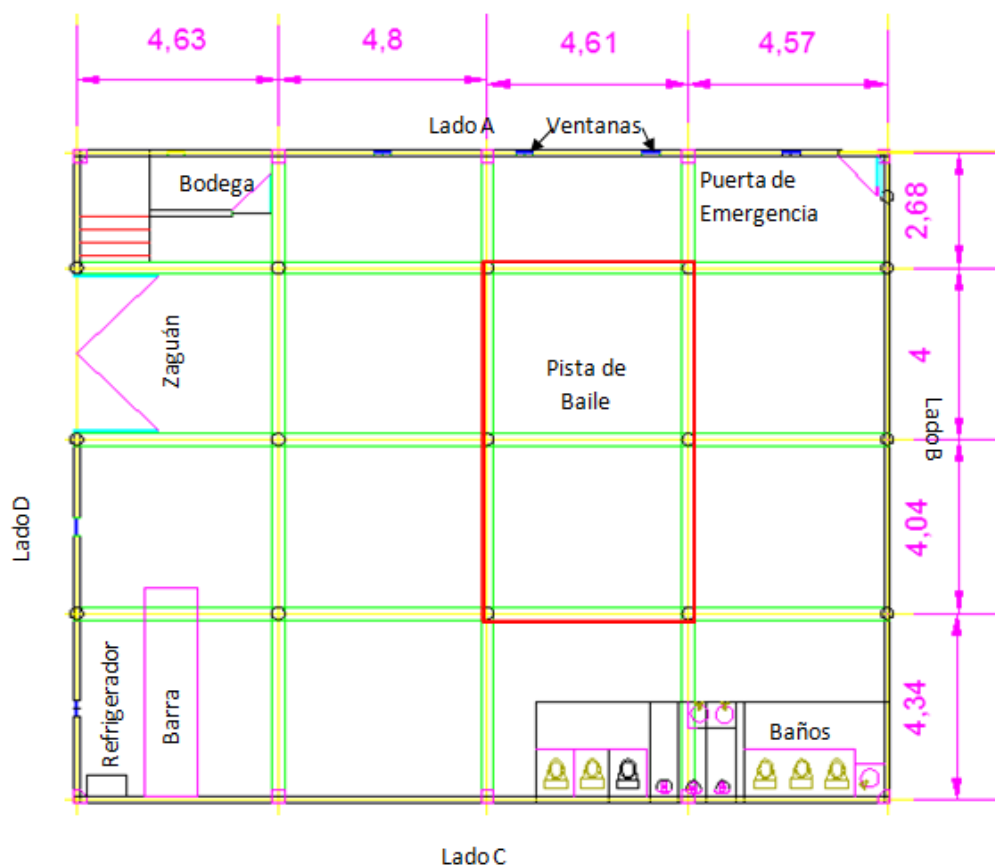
Plano arquitectónico del salón de fiestas "Mirador"
